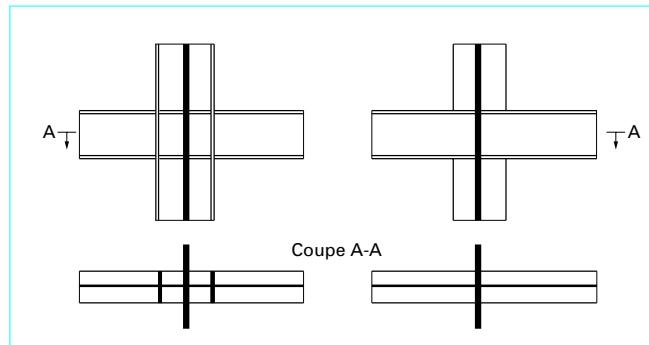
Assemblage montants sur entretoises. Pont multipoutre
